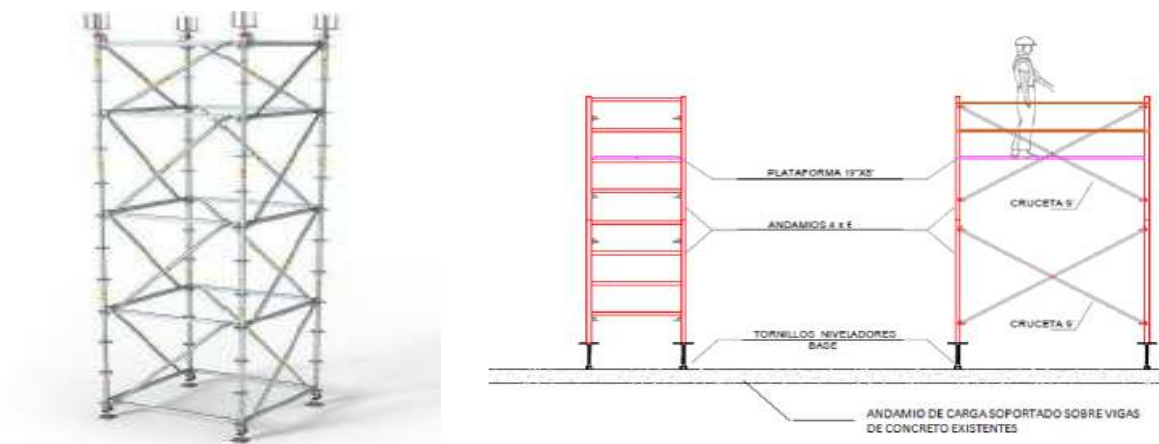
y 19: Sistema de Andamiaje Soportado Sobre Vigas Existentes
